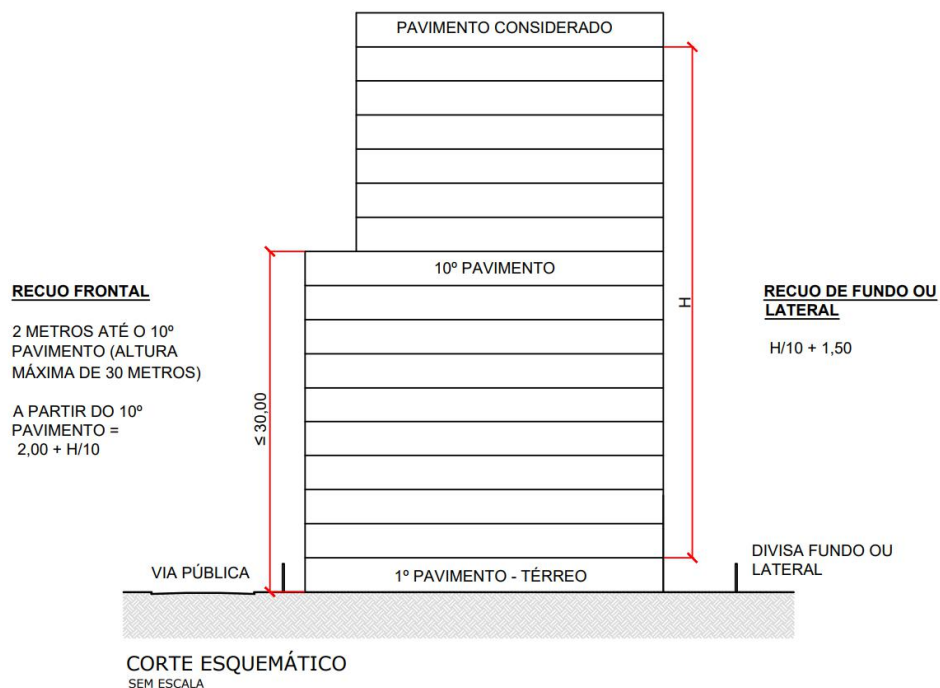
Edifícios com mais de 10 pavimentos, com uma testada
